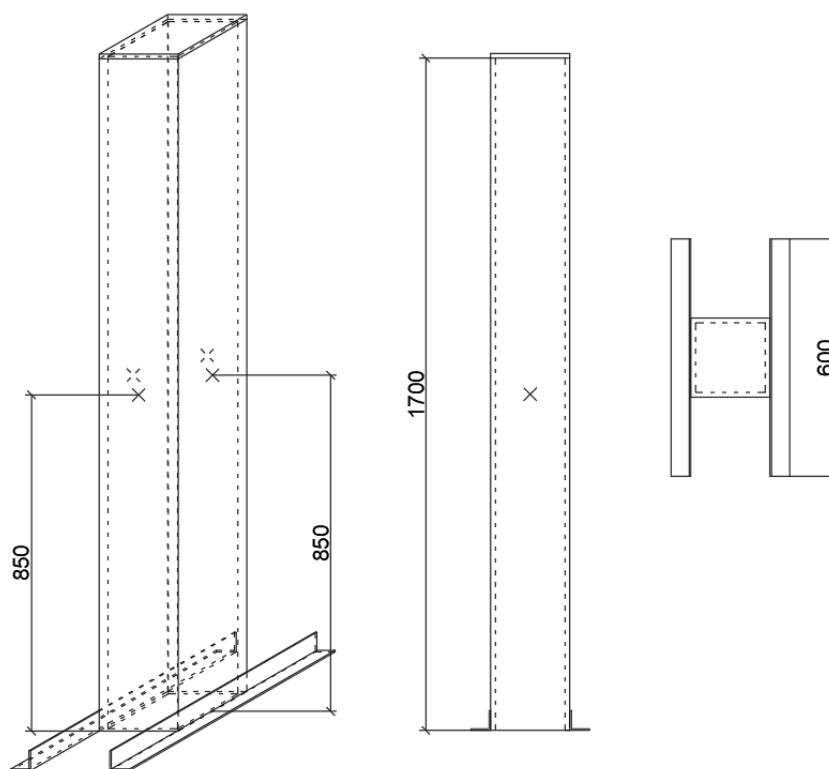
Схема модельной конструкции для проведения испытаний
